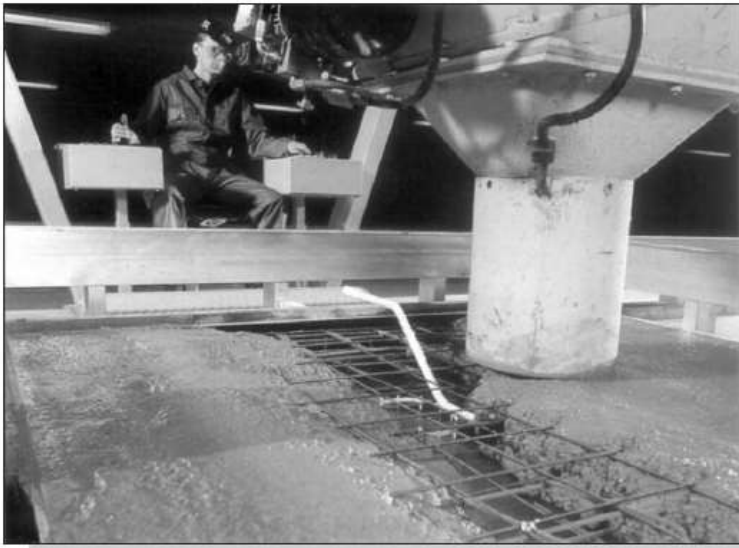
Betonimi i elementeve të parapërgatitura dhe vibrimi në fabrik
